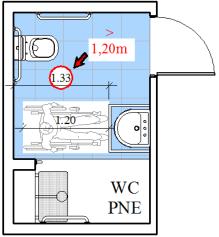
Planta Baixa de WC da UHA (Dimensões mínimas para boxes)
